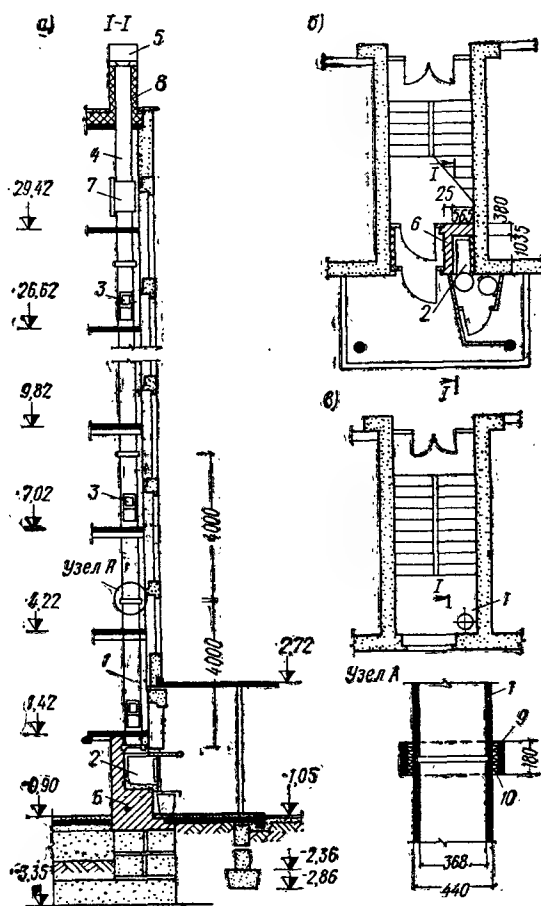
Расположение мусоропровода в лестничной клетке жилого дома
